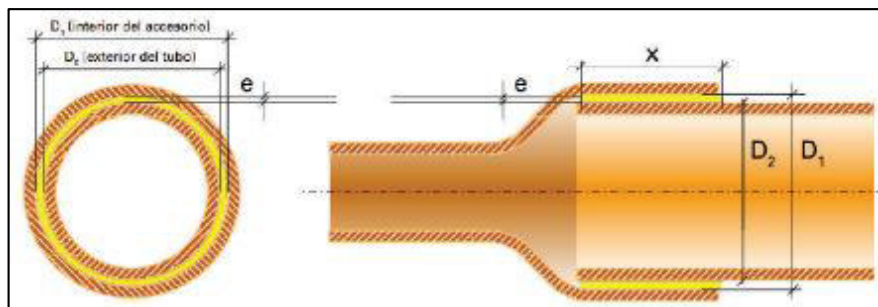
Diseño de una junta soldada (tubería-accesorio) y junta a traslape. (Fuente: [29])
